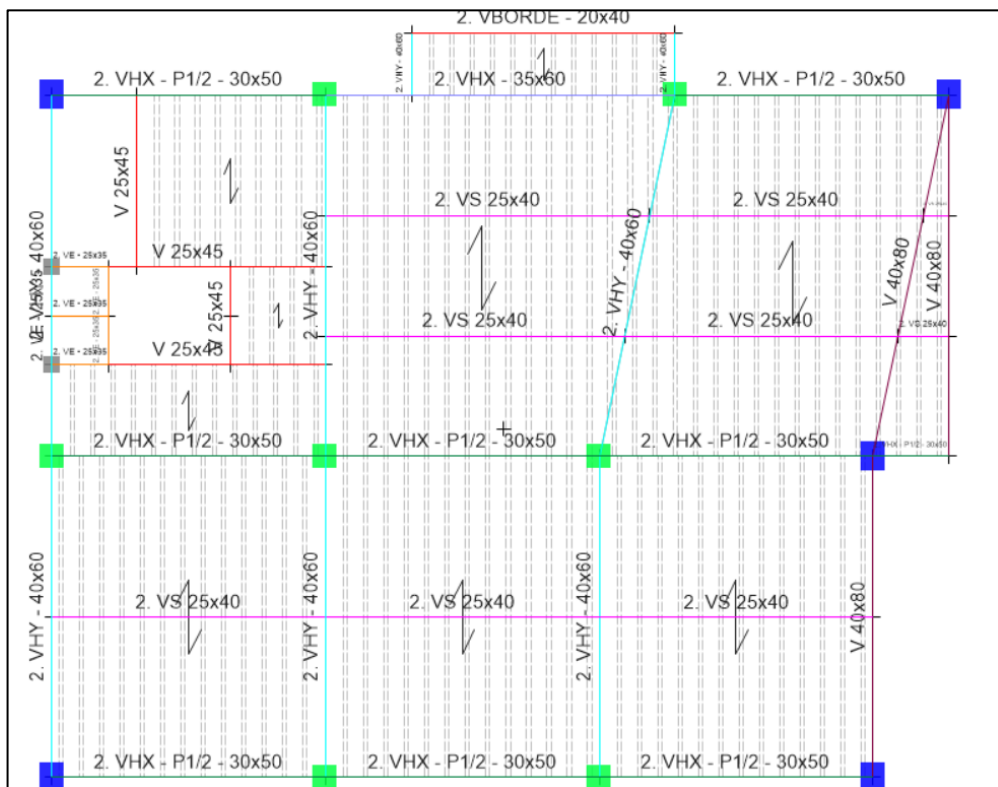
Planta tipo P1 a P2, N.E. +3.60 m a 7.20 m (Castillo & Peñaloza, 2022)
